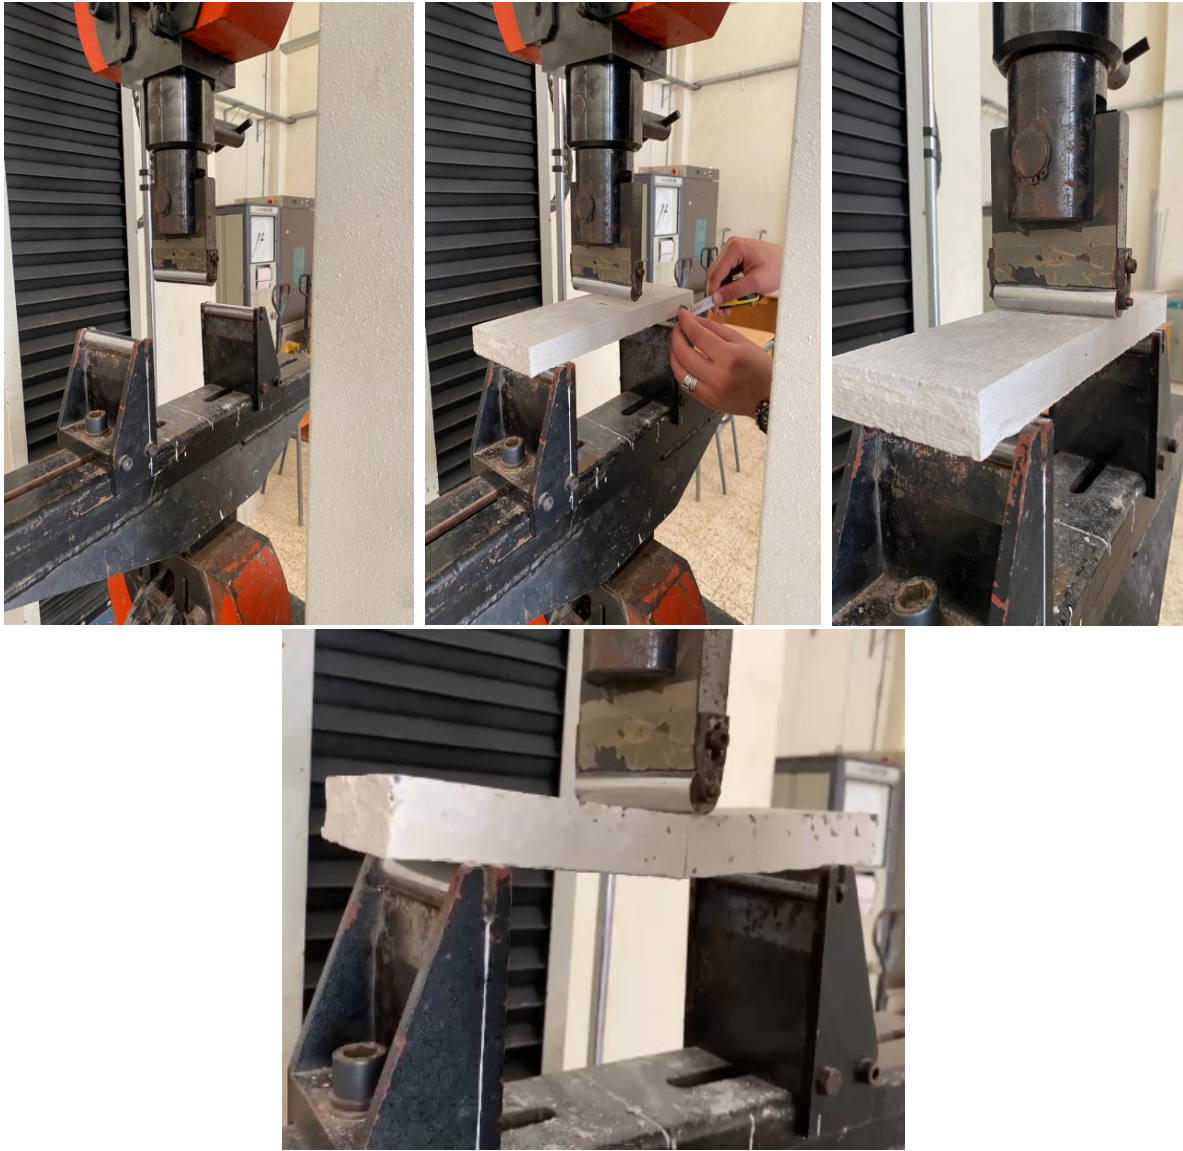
photos montrant la fissuration de l'éprouvette sous l'effet de la force des trois point.
